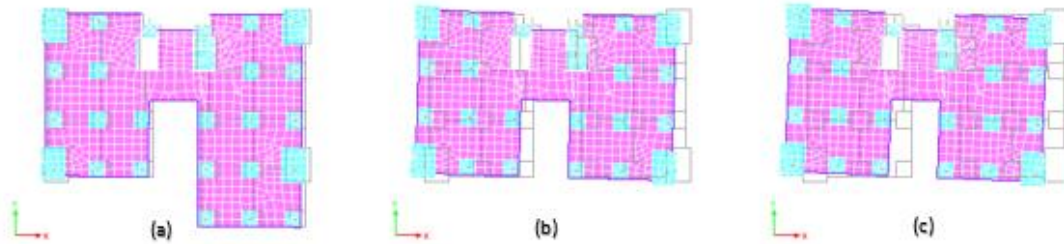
Vista en planta del modo de vibración 1 correspondiente al Caso 1. a) Segunda Planta. b) Quinta Planta. c) Octava Planta.
